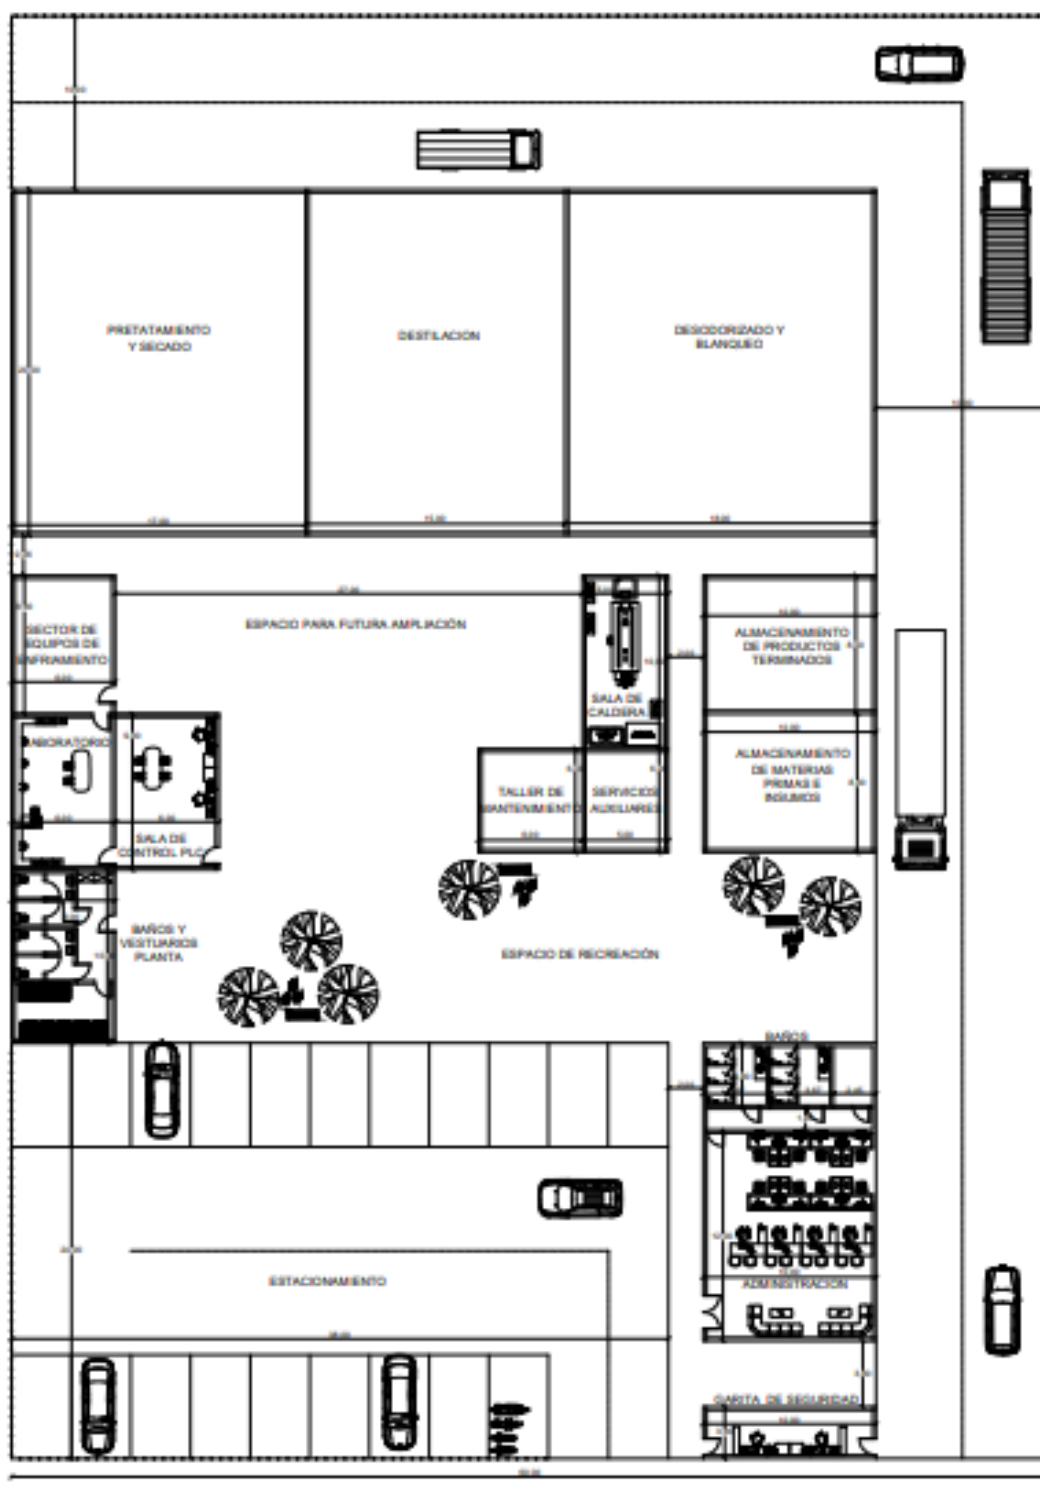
Layout de la planta. Fuente: Elaboración propia.
